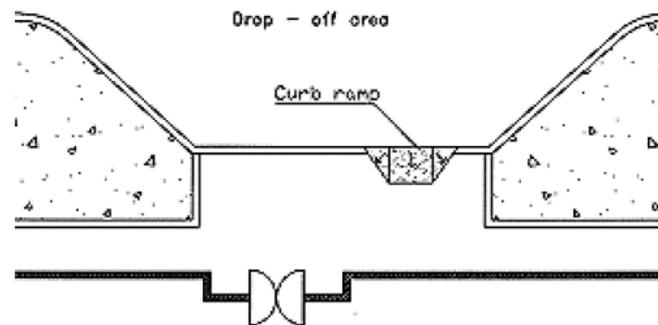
Jenis-jenis Ramp pada Kerb
